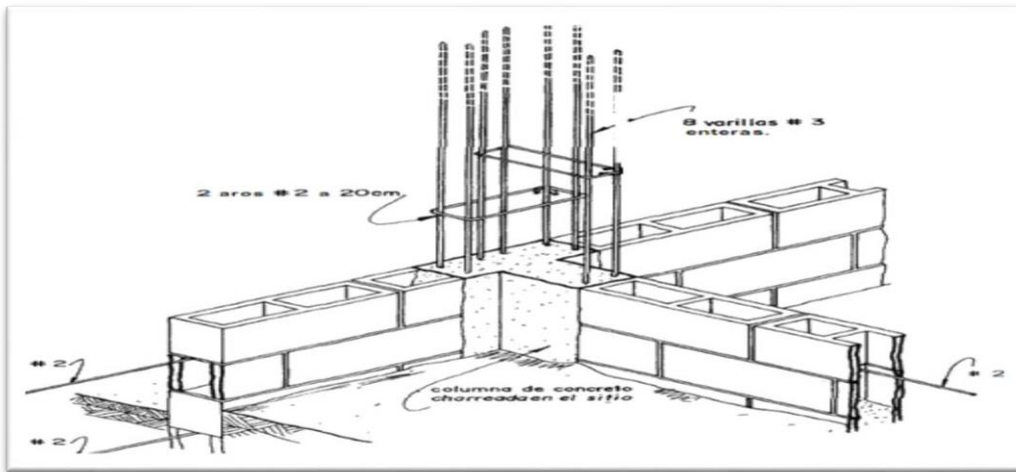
Blog Constructor civil. (21 de mayo de 2012). Mampostería con columnas de concreto reforzado, Chorreadas en SITIO.. Septiembre de 2020, de Blog Constructor civil Sitio web: <https://www.elconstructorcivil.com/2012/05/mamposteria-con-columnas-de-concreto.html>
